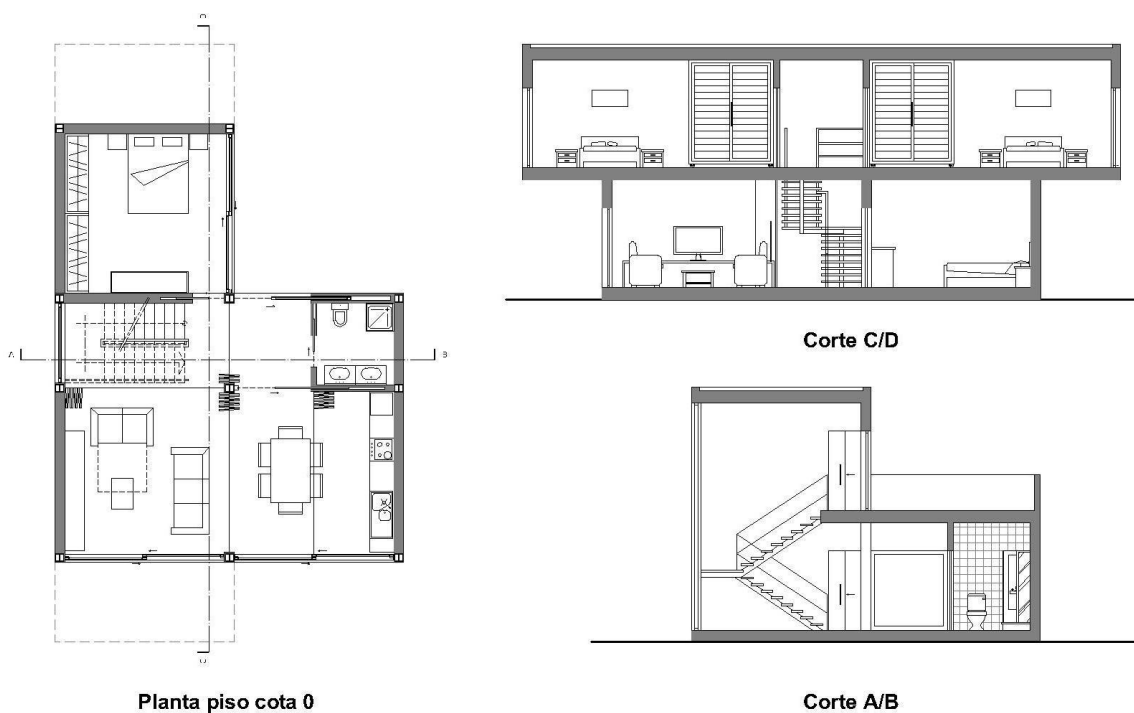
Planta piso cota 0 e cortes (3ª fase)
